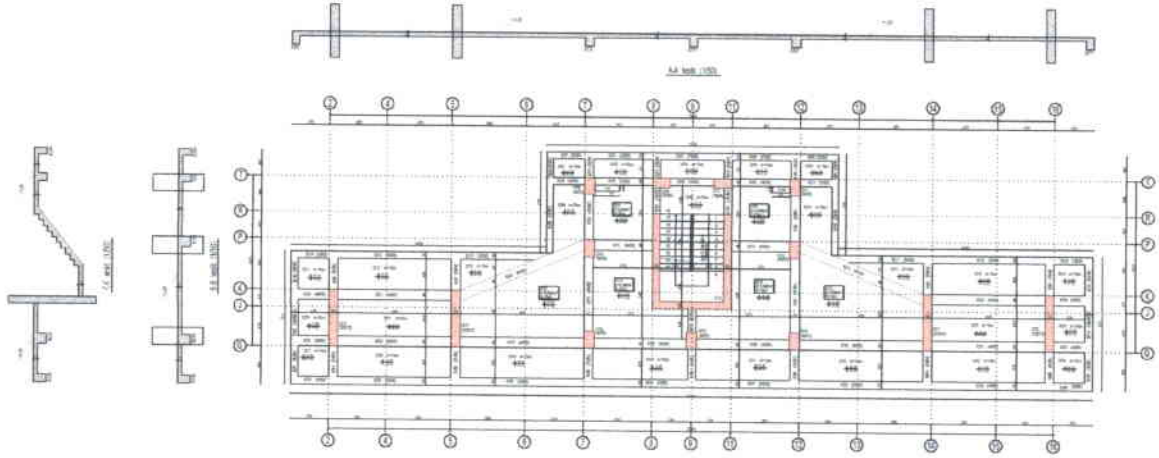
A1 Blok 8. Kat Kalıp Planı(A-1 Blok)
